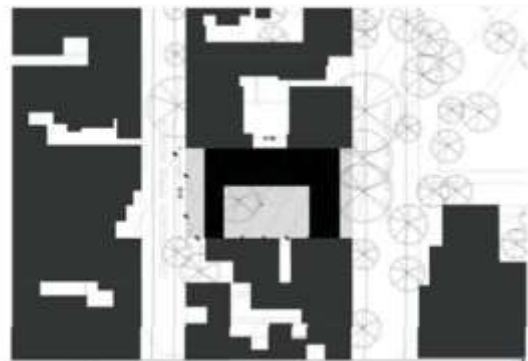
Esquema de llenos y vacíos en planta – Trabajo de María Luz Juliá – Elaboración propia
